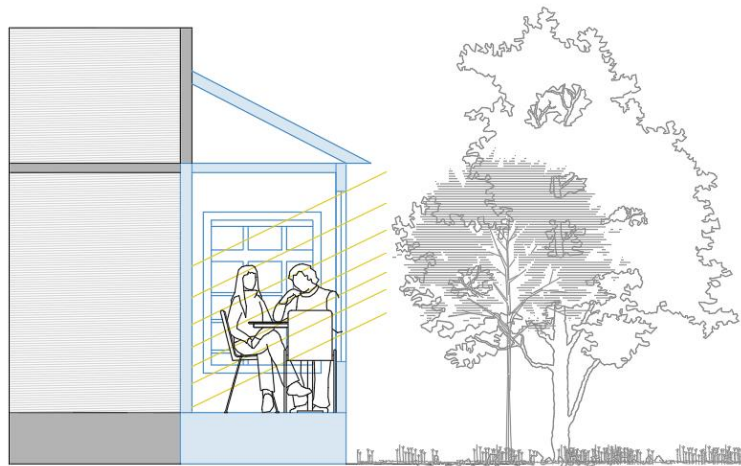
Corte esquemático de galería Casa Cruces. Fuente: Elaboración Propia
